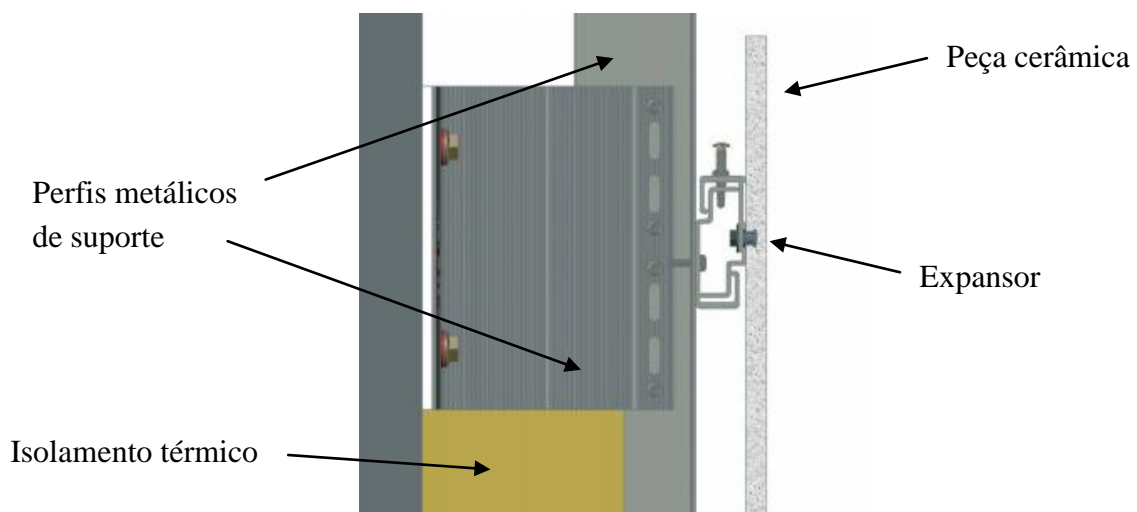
Exemplo de montagem de uma fachada ventilada com recurso a expansores (adaptado de EuroFOX - @2009 [5])
